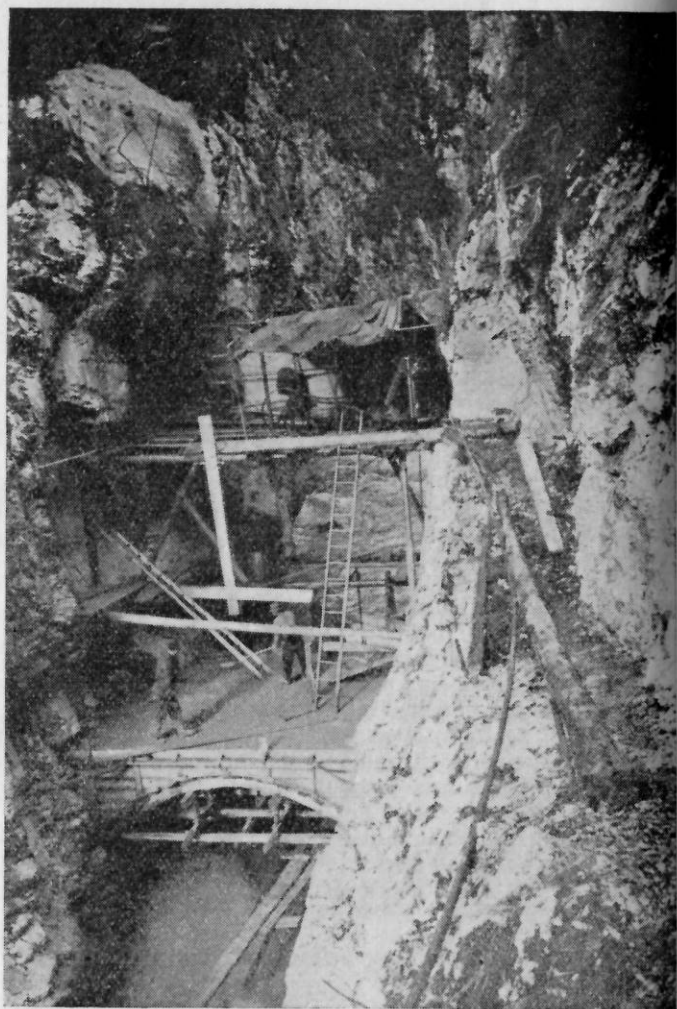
Diaframma subalveo nel Coritena. Vista del cantiere nella forra; a destra sull'impalcato sonda rotativa; sotto, il ponte di servizio in calcestruzzo.
